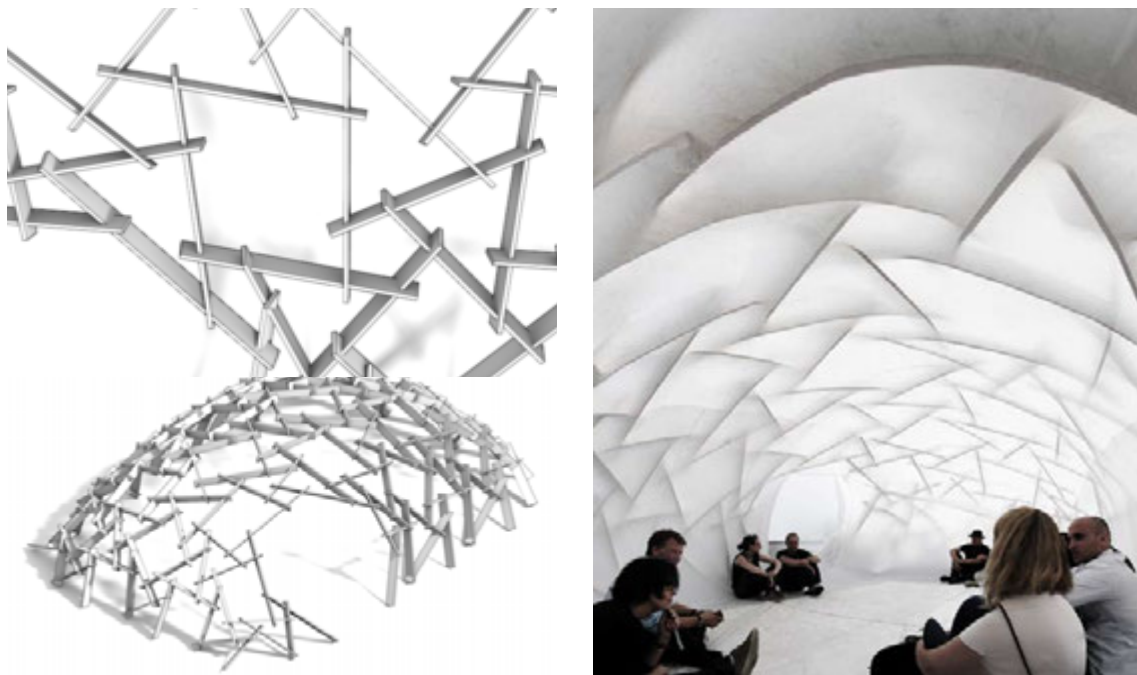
Rendering Außenhülle Test Pavillon und Aufbau während der ArchitekturArena
